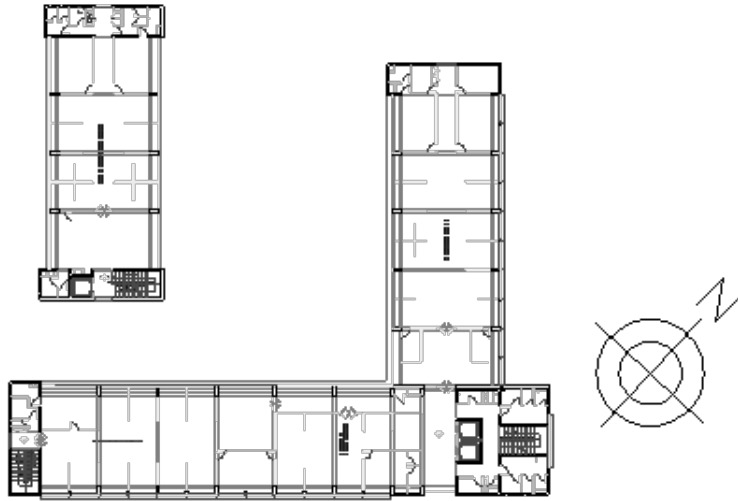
Planta Piso 2 a Planta piso 5 – Oficinas – Nivel +4,50 hasta +15,90
